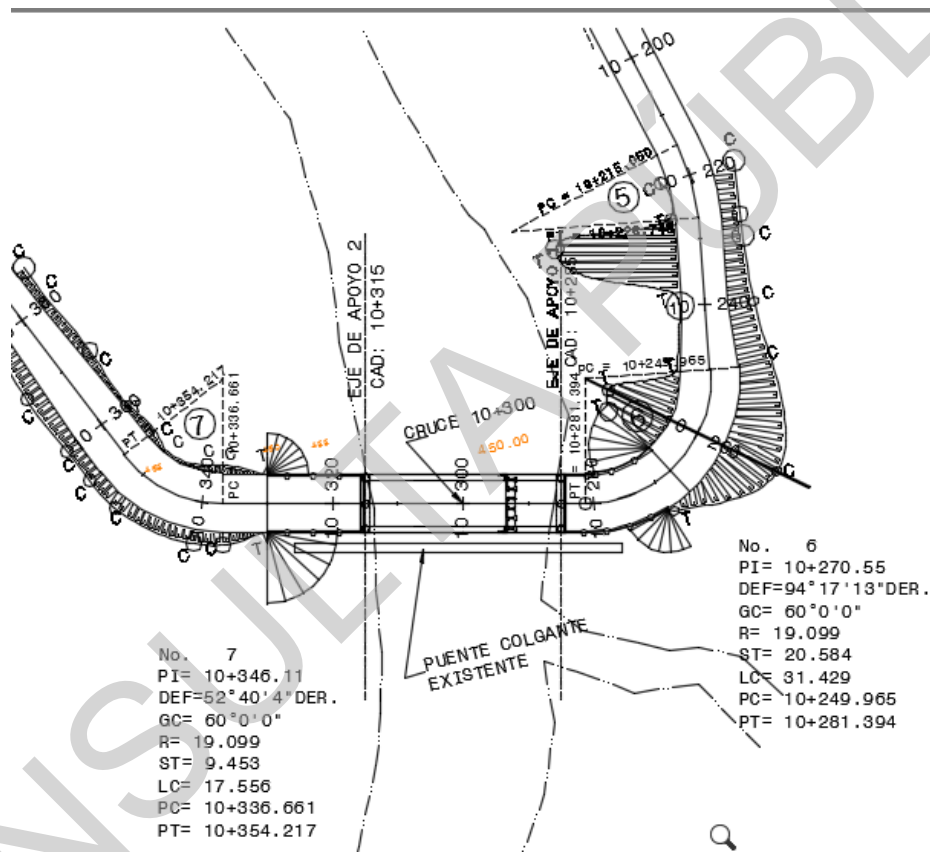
Planta general del proyecto de construcción del puente "Río Bobo".
